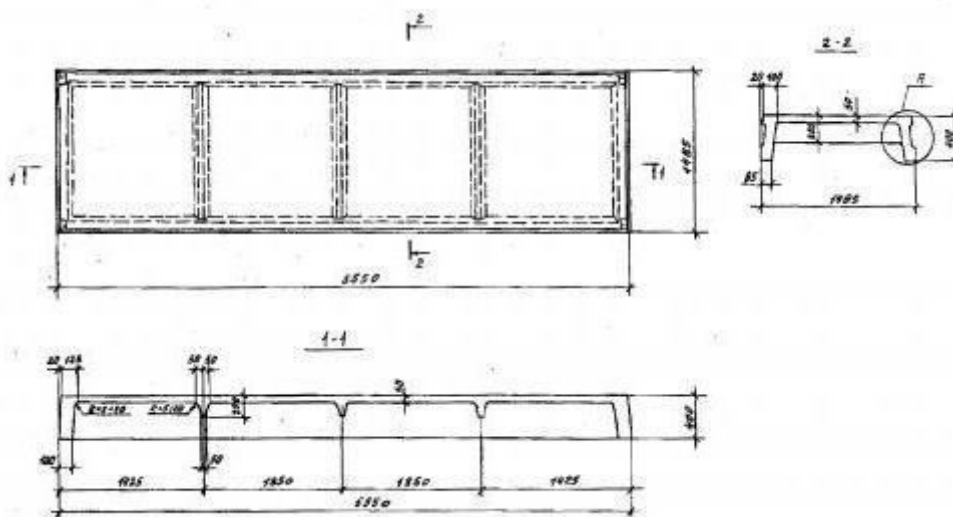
Ребристая плита перекрытия габаритами 1.48x5.55x0.4
